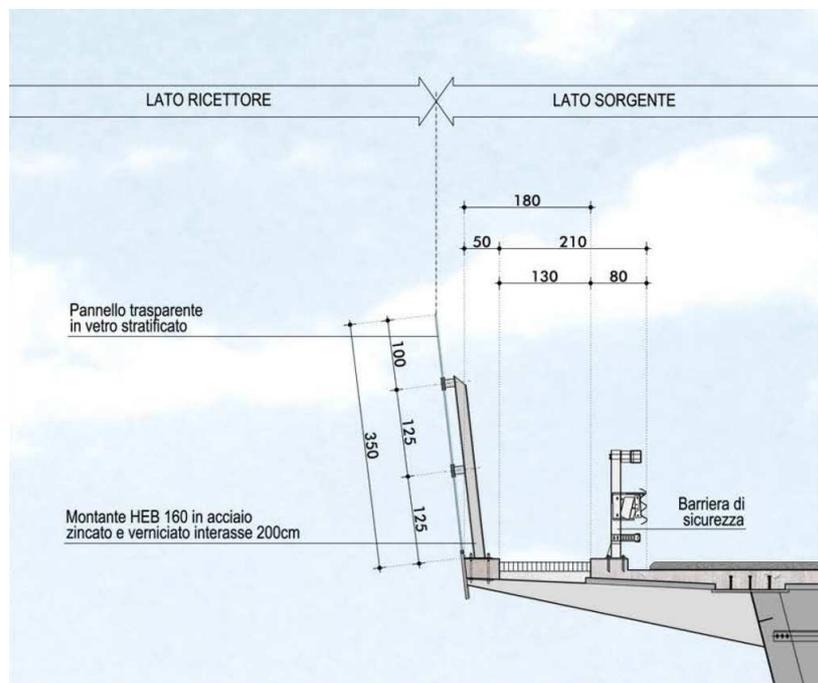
ESEMPIO DI SEZIONE TIPO CON BARRIERA TRASPARENTE SUL VIADOTTO CROSTOLO
